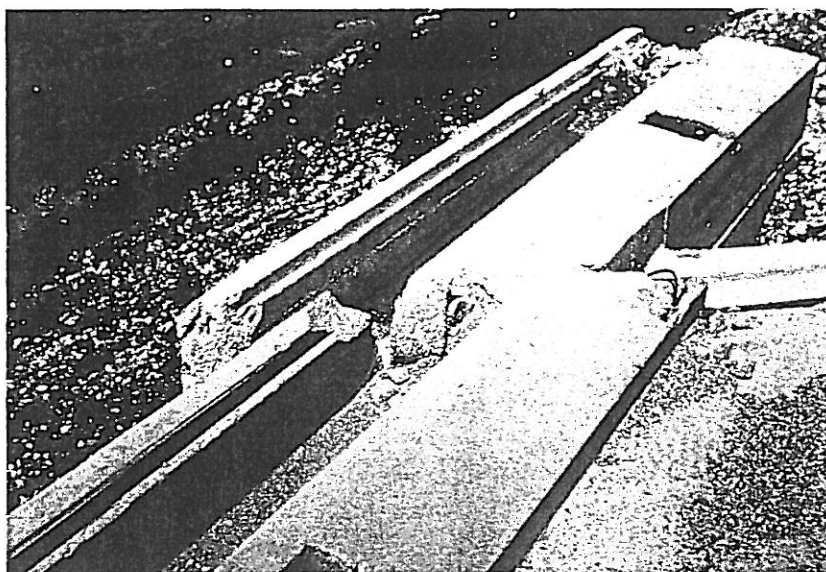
Scorrimento di un impalcato da ponte rispetto alla spalla (Friuli, 1976).
